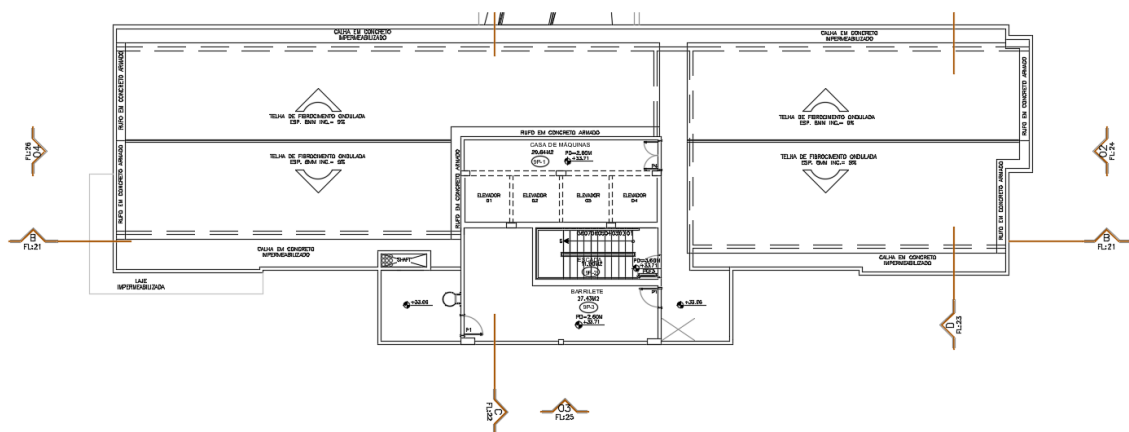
Planta baixa do 9º pavimento técnico da torre B.
